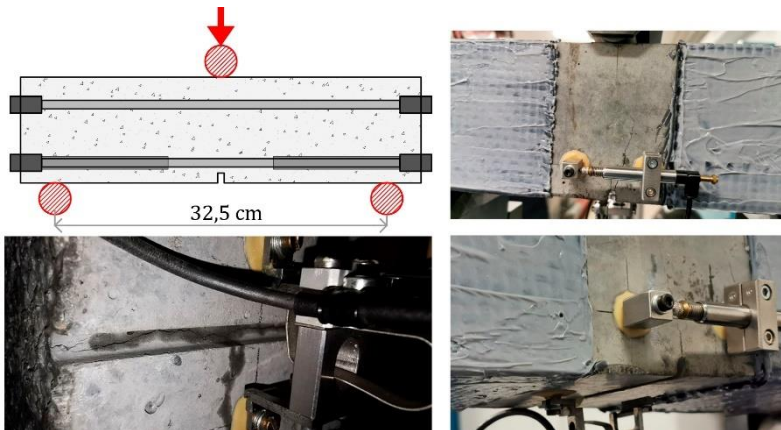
47- Proceso de fisuración. Elaboración propia.
